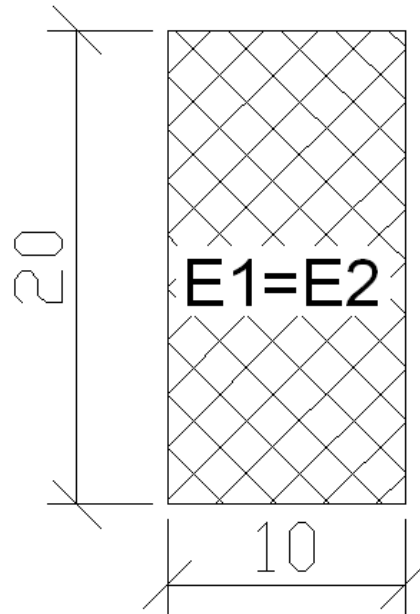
Aparelho de neoprene fretado+PTFE em planta (dimensões em cm).
